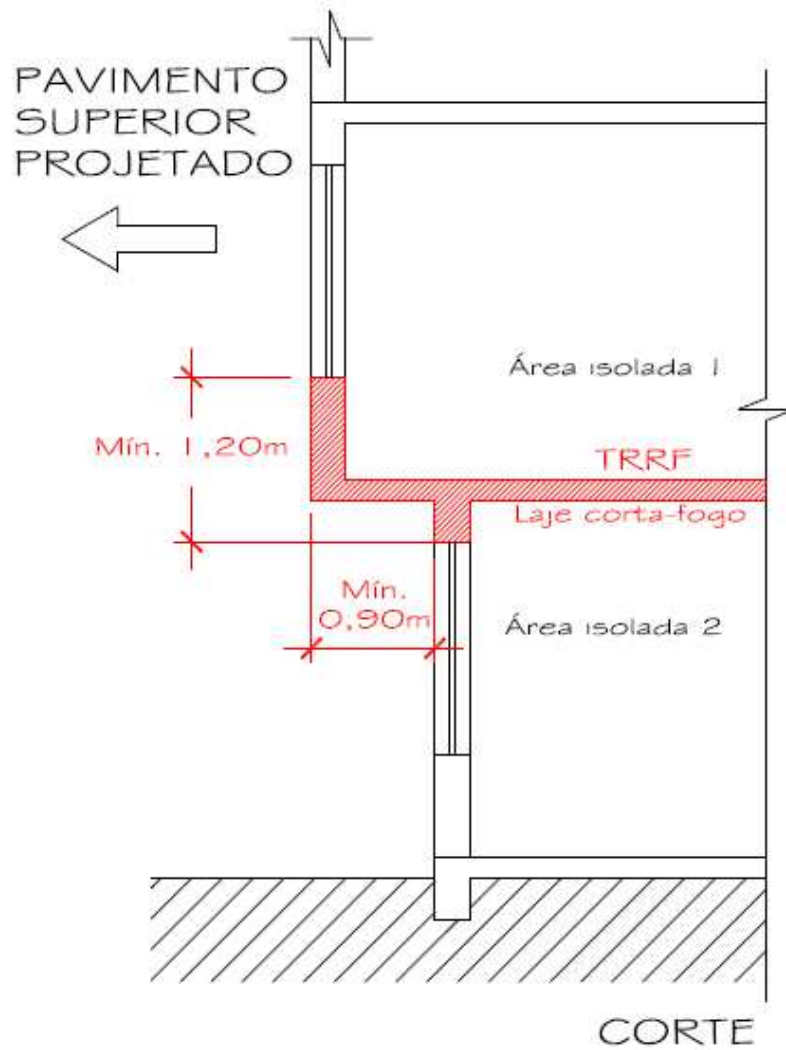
Distância vertical entre aberturas dotadas de projeção em balanço entre pavimentos isolados
